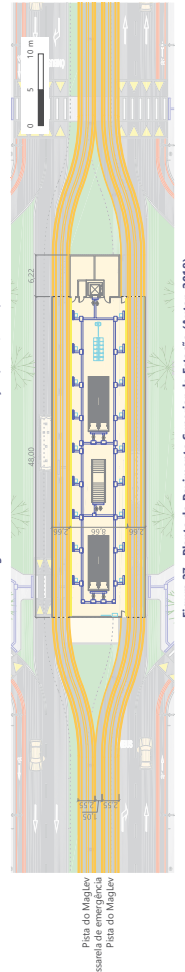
Planta do Pavimento Superior da Estação (Autor, 2018)
